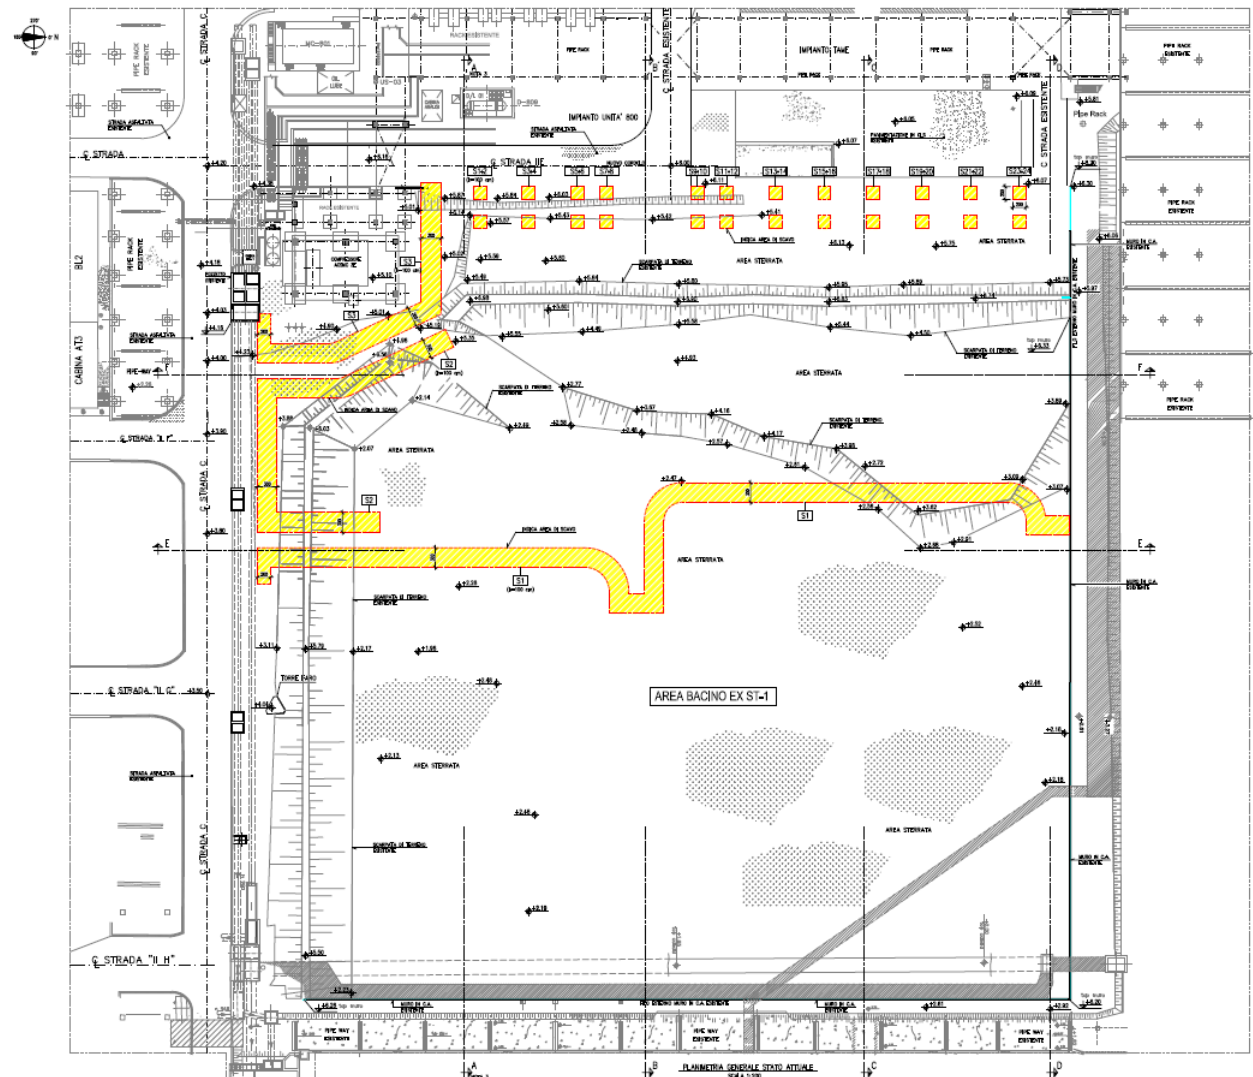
planimetria stato attuale con indicazione degli scavi in giallo
